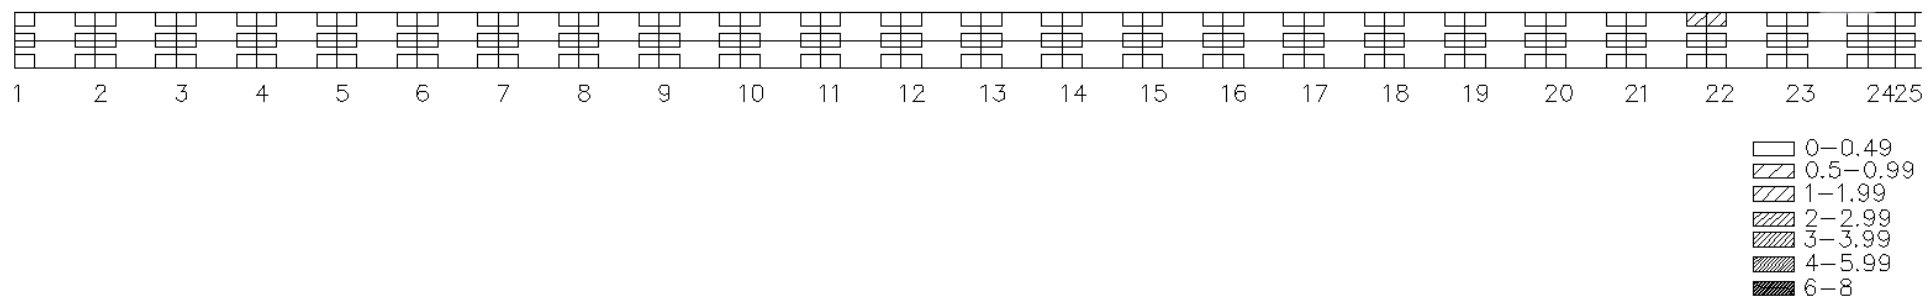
Frästiefen bei kubischer Splinefunktion und Verfahrensplan Typ V, Grundriss, Stationen 1-25
